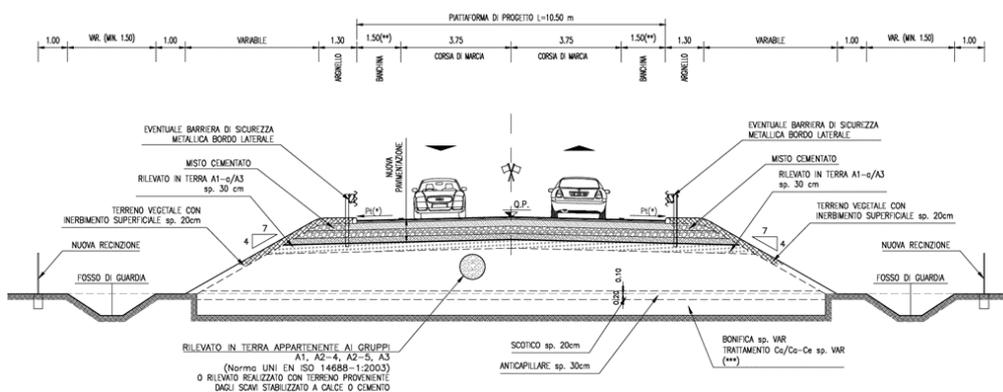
Sezione tipo rampa bidirezionale in rilevato
